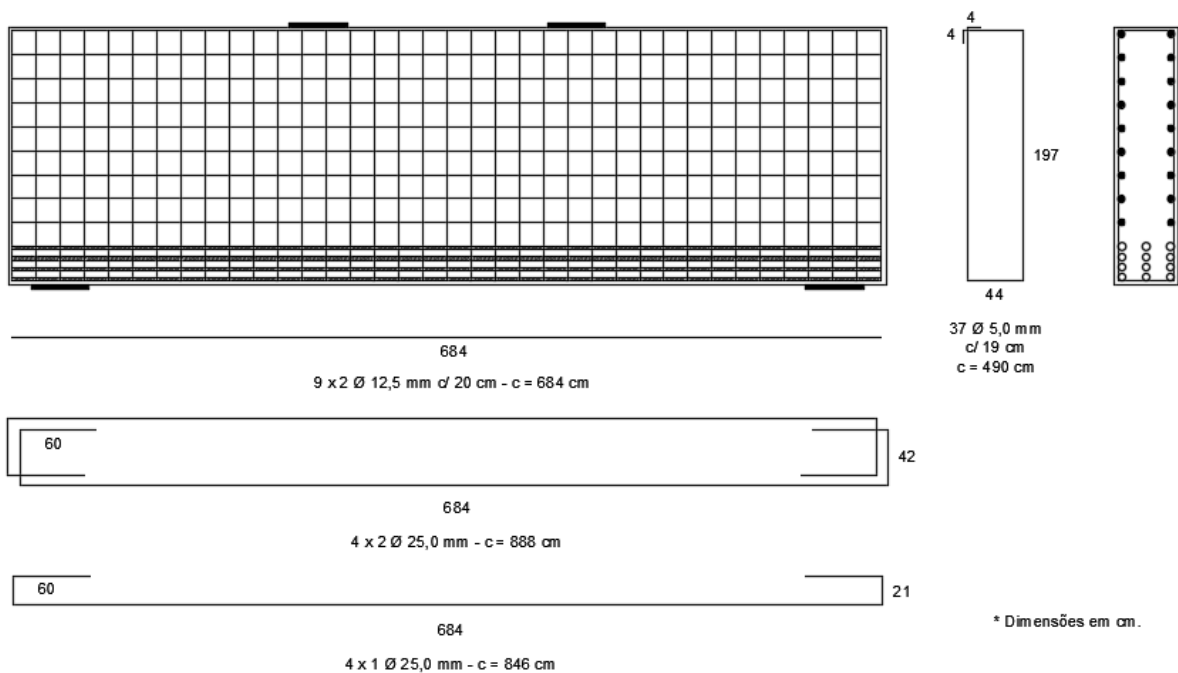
Detalhamento da armadura do modelo de viga-parede A, obtido com dimensionamento segundo ABNT (2014)
